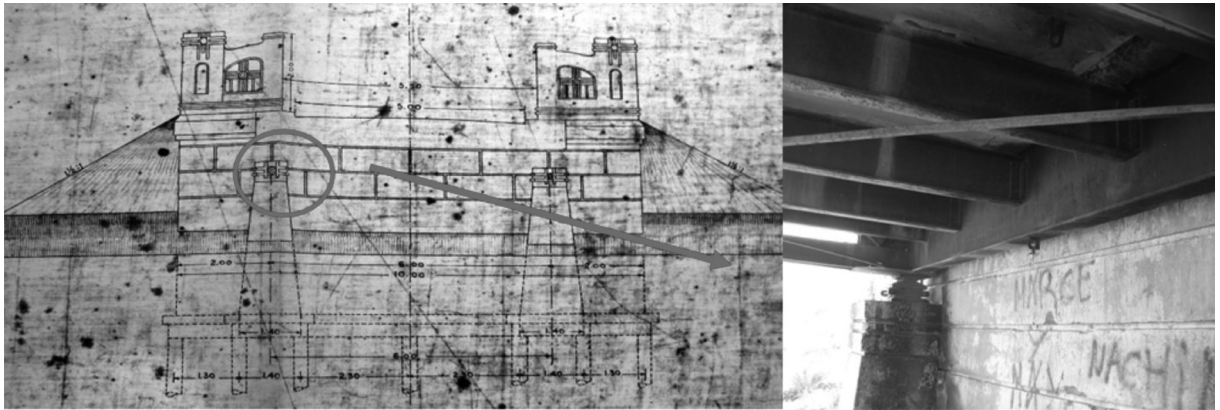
Plano de obra. Sección transversal de las fundaciones. Detalles de unión con la superestructura.
